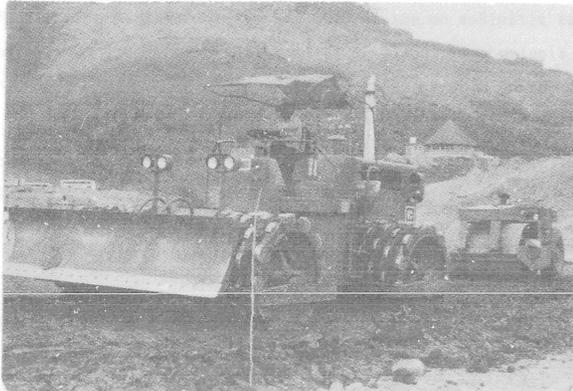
RODILLO DE IMPACTO (TAMPING-ROLLER)
